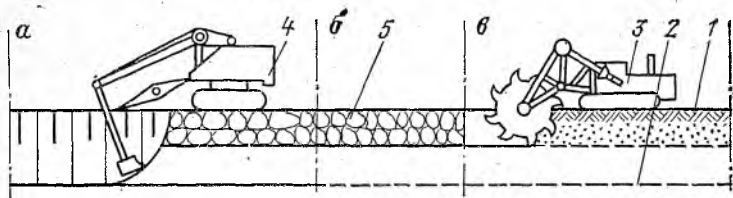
Схема производства работ по рыхлению мерзлого грунта щелевыми зарядами при разработке траншей:
